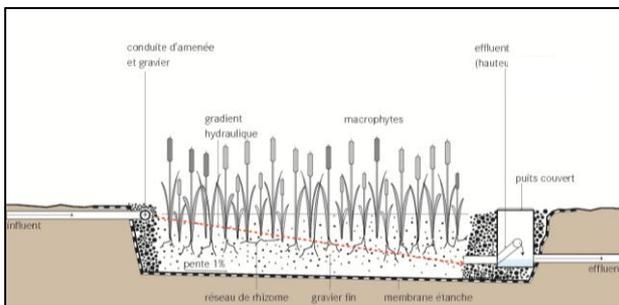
Forme du bassin, succession des composants, circuit de l'eau et gradient hydraulique dans un filtre planté à écoulement subsurface (de sous la surface) horizontal (source: Tilley et al., 2008).
